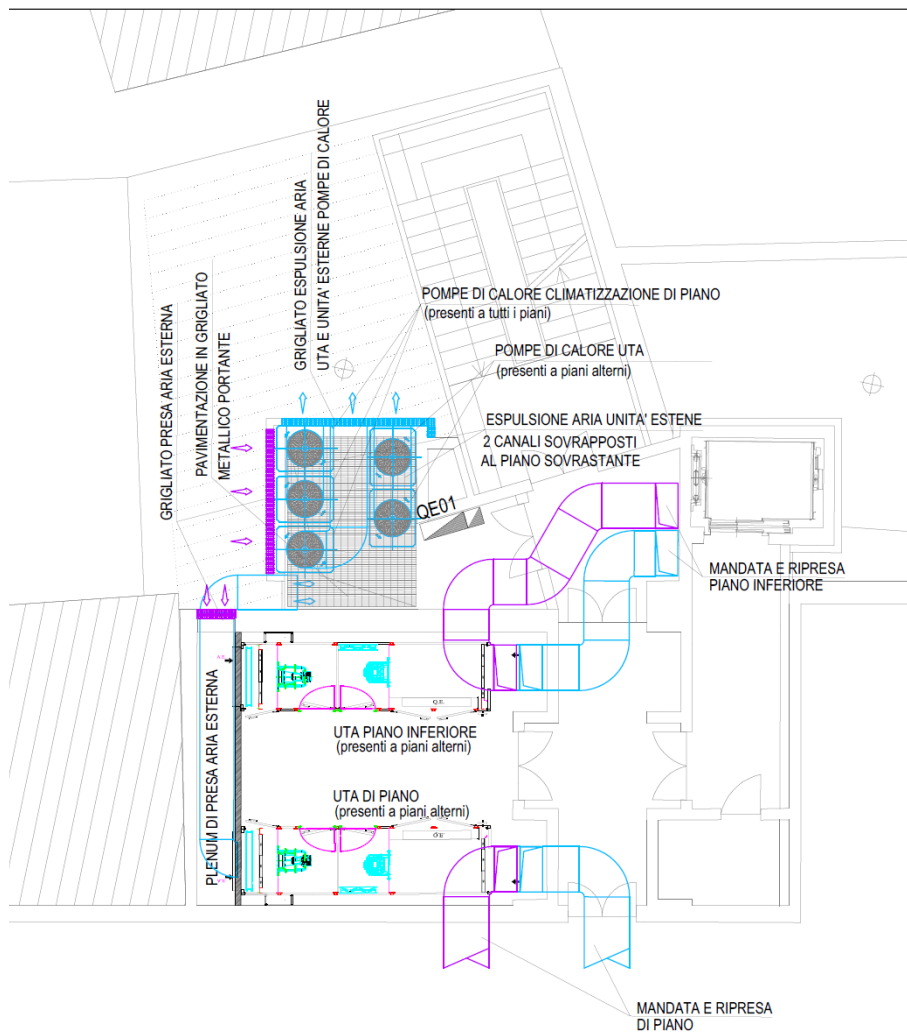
Posizionamento degli impianti. Pianta piano tipo.
